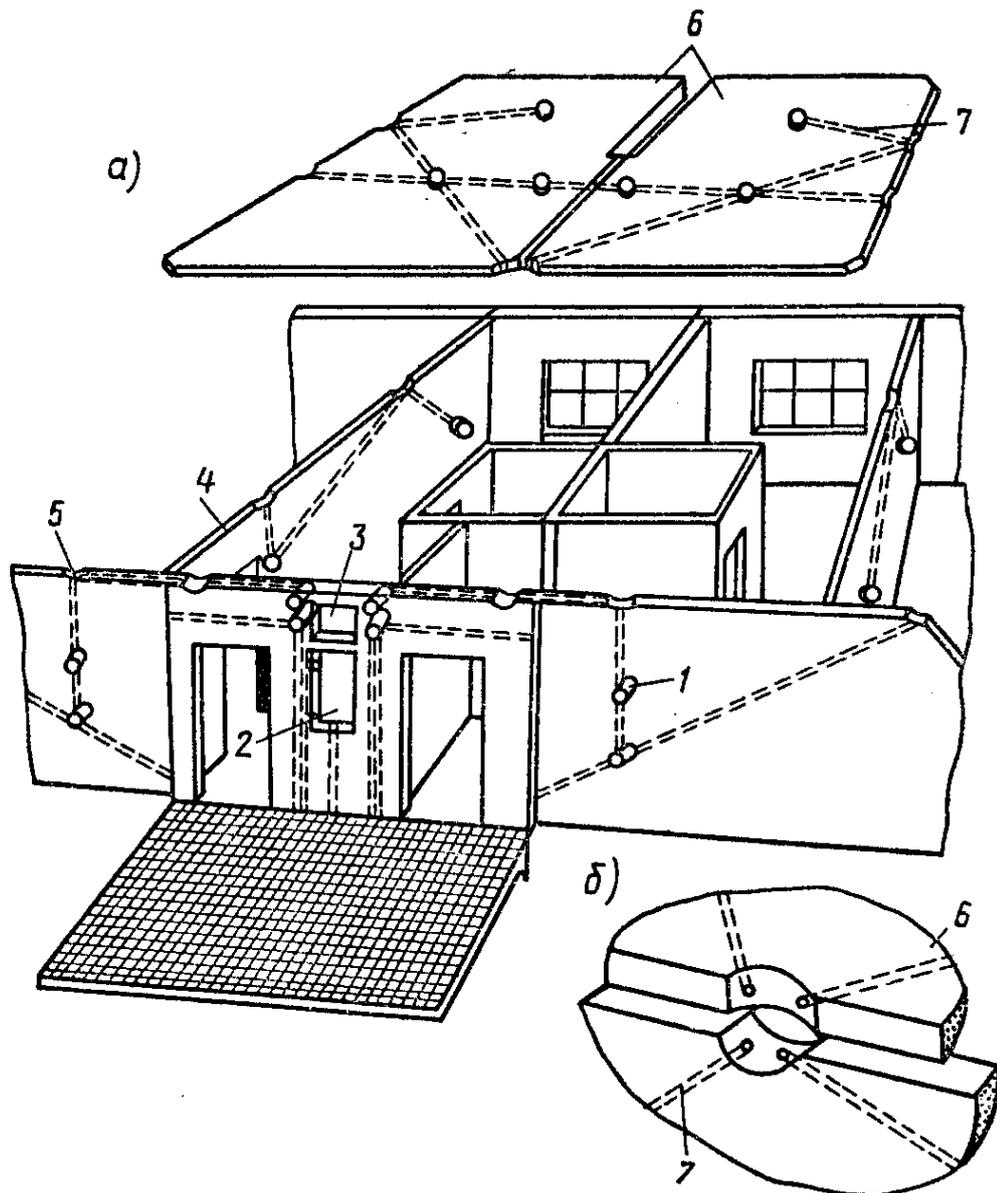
Электропроводка в каналах крупнопанельного дома: *а* - общий вид строительного участка; *б* - узел сопряжения каналов стеновой панели и панели перекрытия; 1 - гнездо для штепсельных розеток и выключателей; 2 - ниша распределительного щитка; 3 - ниша слаботочного устройства; 4 - стеновая панель; 5 - выемка в панели; 6 - панель перекрытия; 7 - канал для проводов
